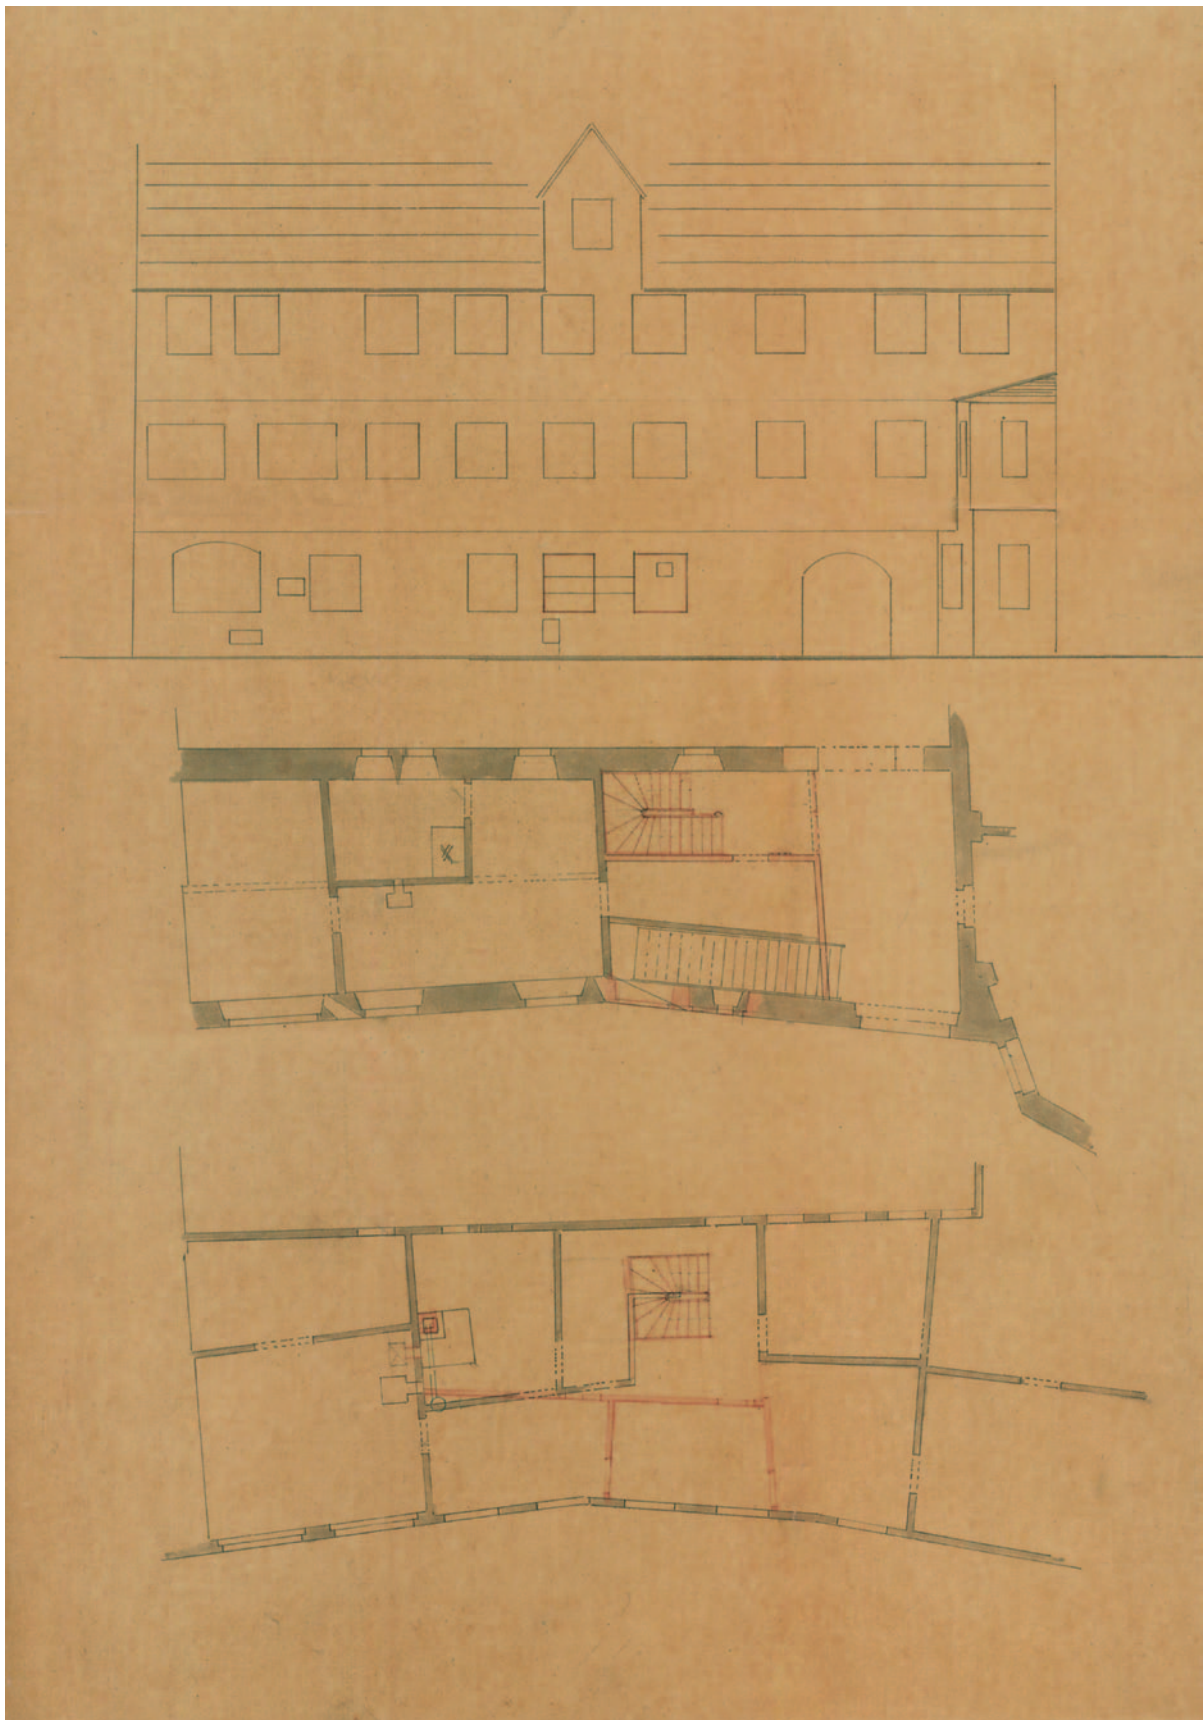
Gebäude Köpfingergasse 9 (A 141), Ansicht und Grundrisse, Baugesuch 1870.
